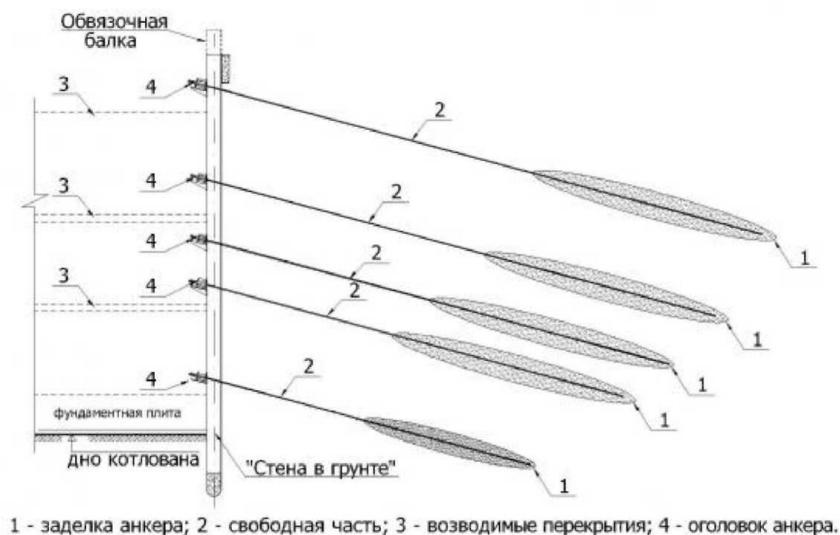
Конструкція ґрунтового анкера на прикладі його застосування при зміцненні стінок котловану [83]
